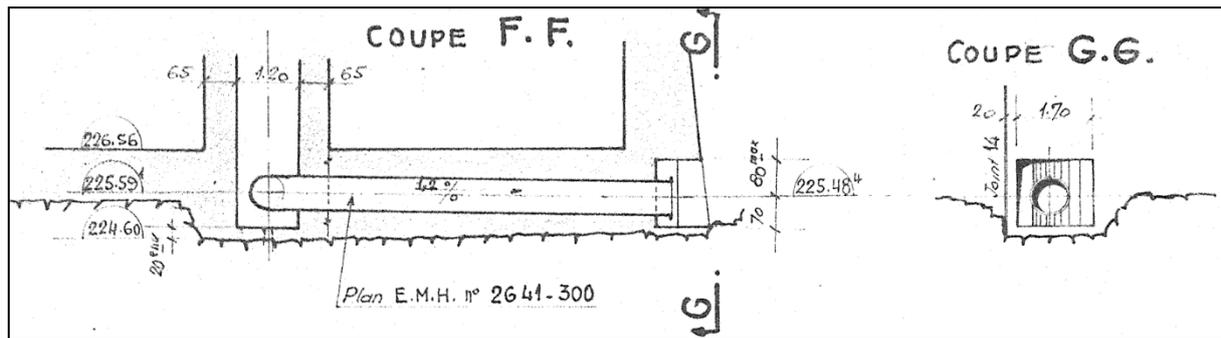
Vues en plan et en coupe de la chambre de restitution aval
